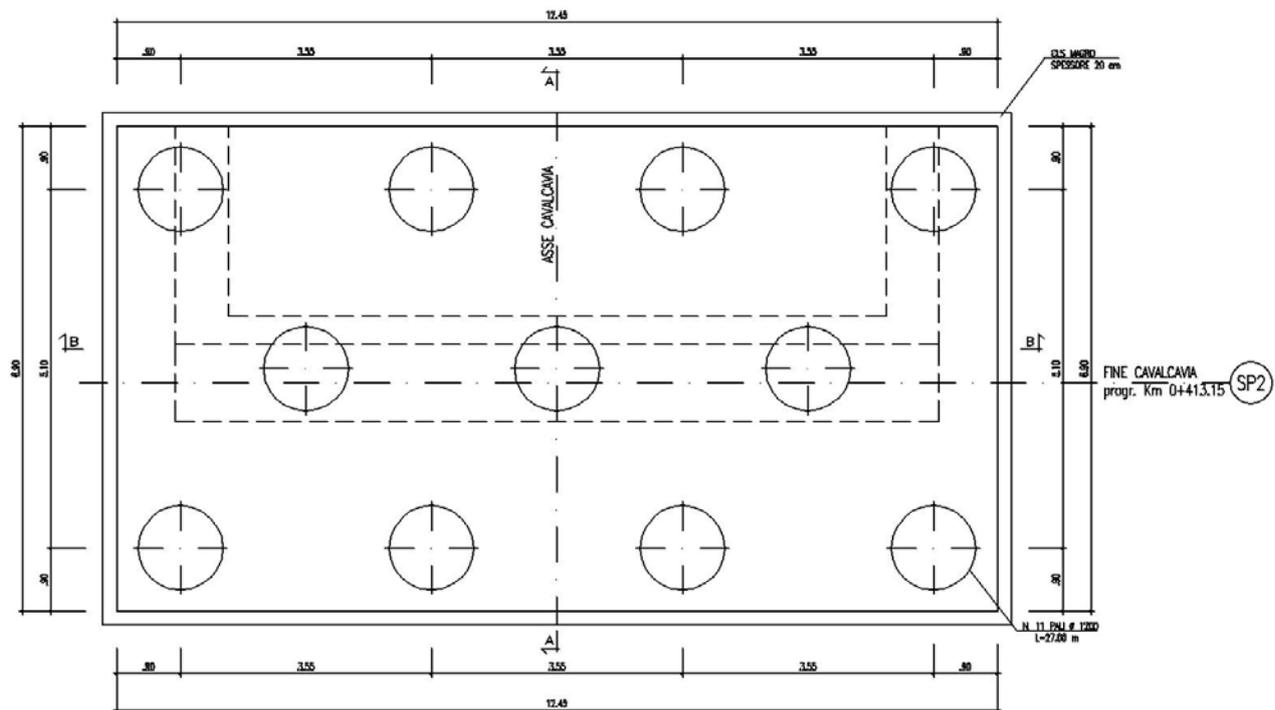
pianta spiccato fondazione della spalla 2.
